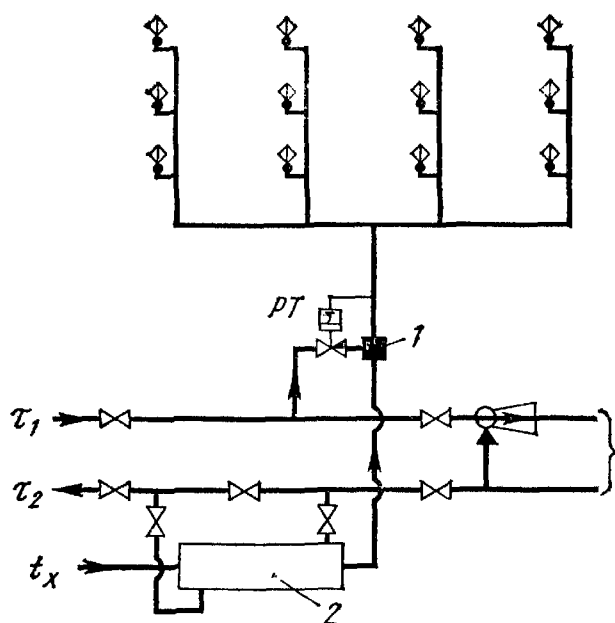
Схема горячего водоснабжения с подмешиванием водопроводной воды
